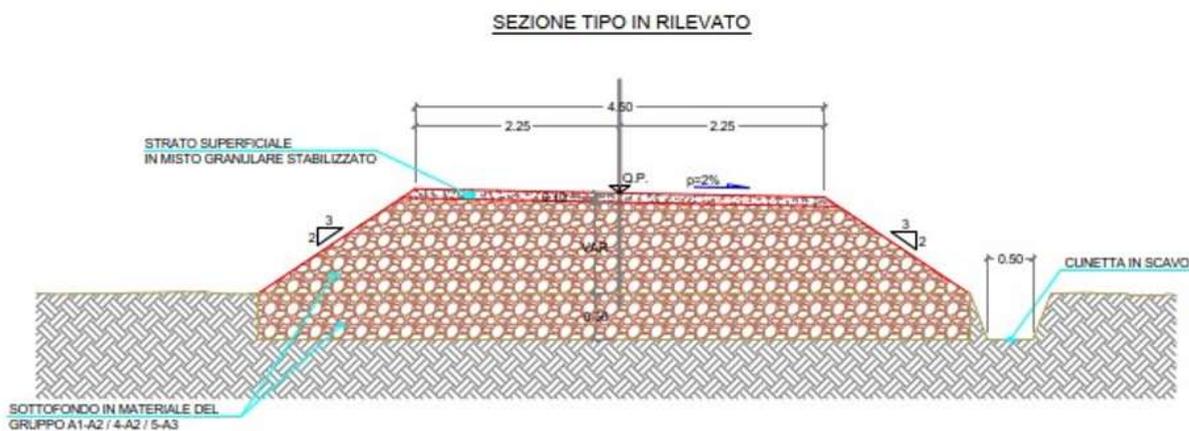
Sezione stradale "tipo" IN RILEVATO della viabilità di progetto (strade di accesso alle piazzole e relativo pacchetto stradale)
